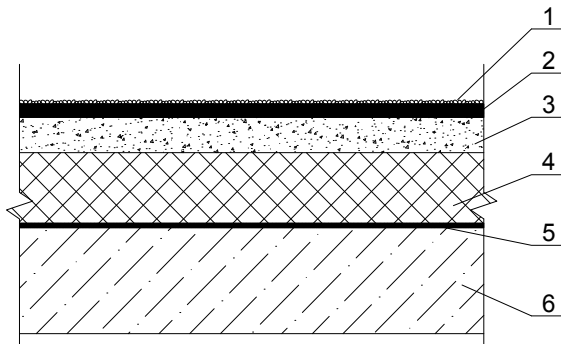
Совмещенная кровля с прямым размещением слоев:
